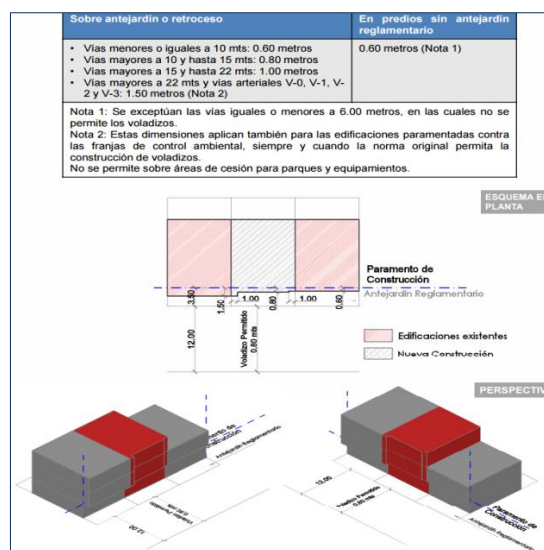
Detalle de Voladizos Decreto 562 de 2014 - Fuente: SDP
